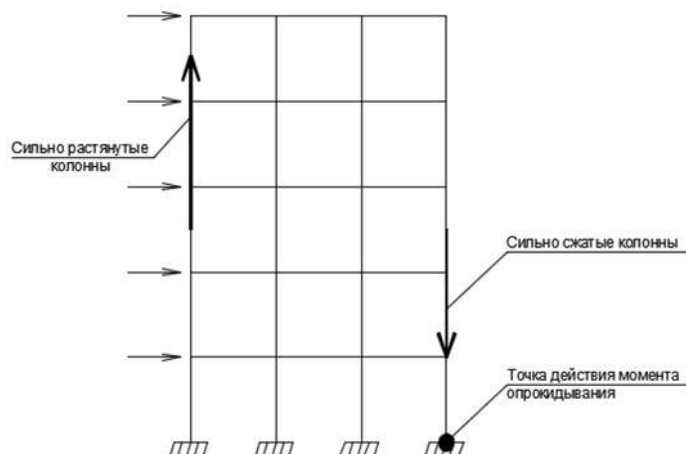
Влияние сейсмической нагрузки на работу колонн каркаса
